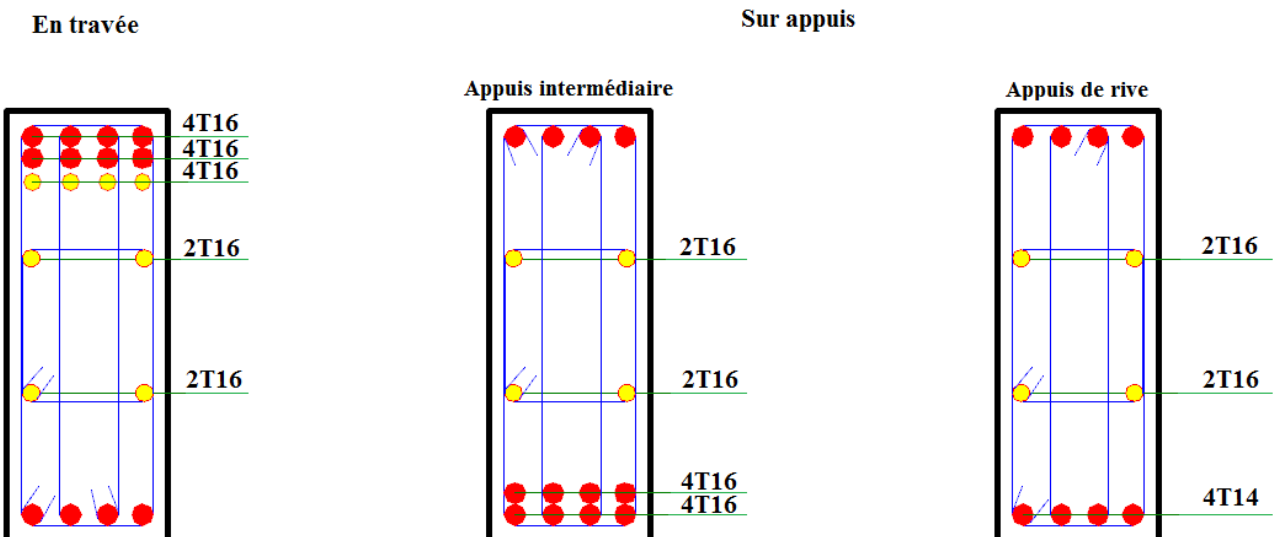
Ferrailage de la poutre de libage (sens longitudinal)
